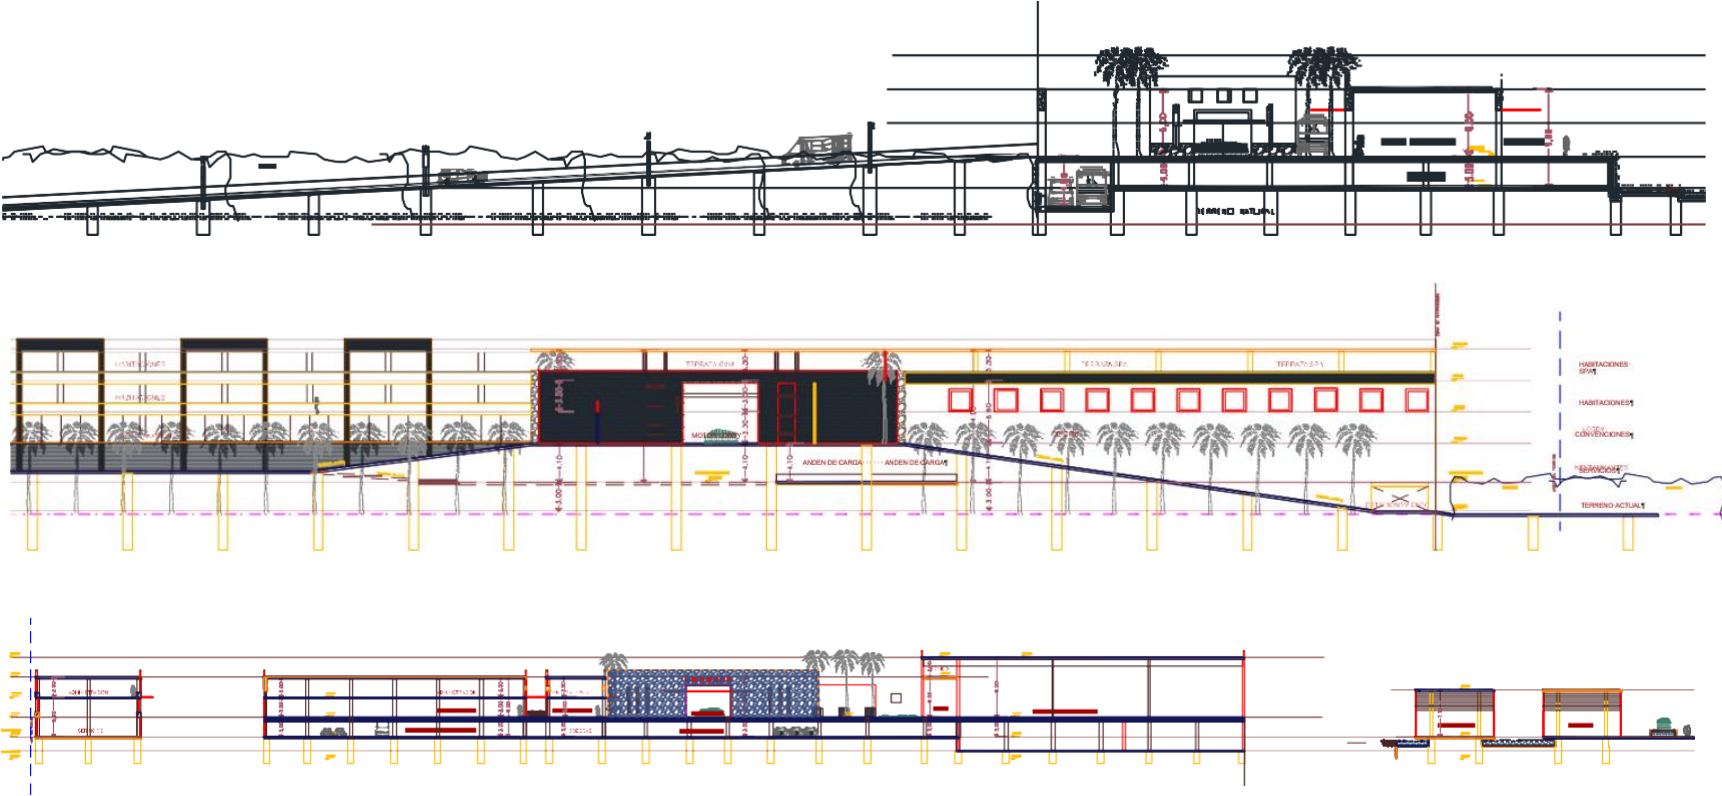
Imágenes de los cortes y fachadas del proyecto NINE
